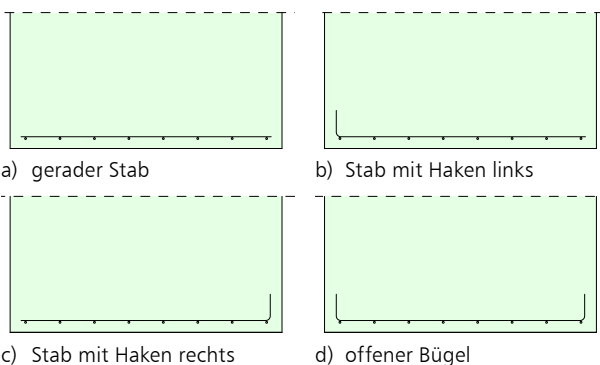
Stabstahl Bügelform – seitlich horizontale Bewehrung
